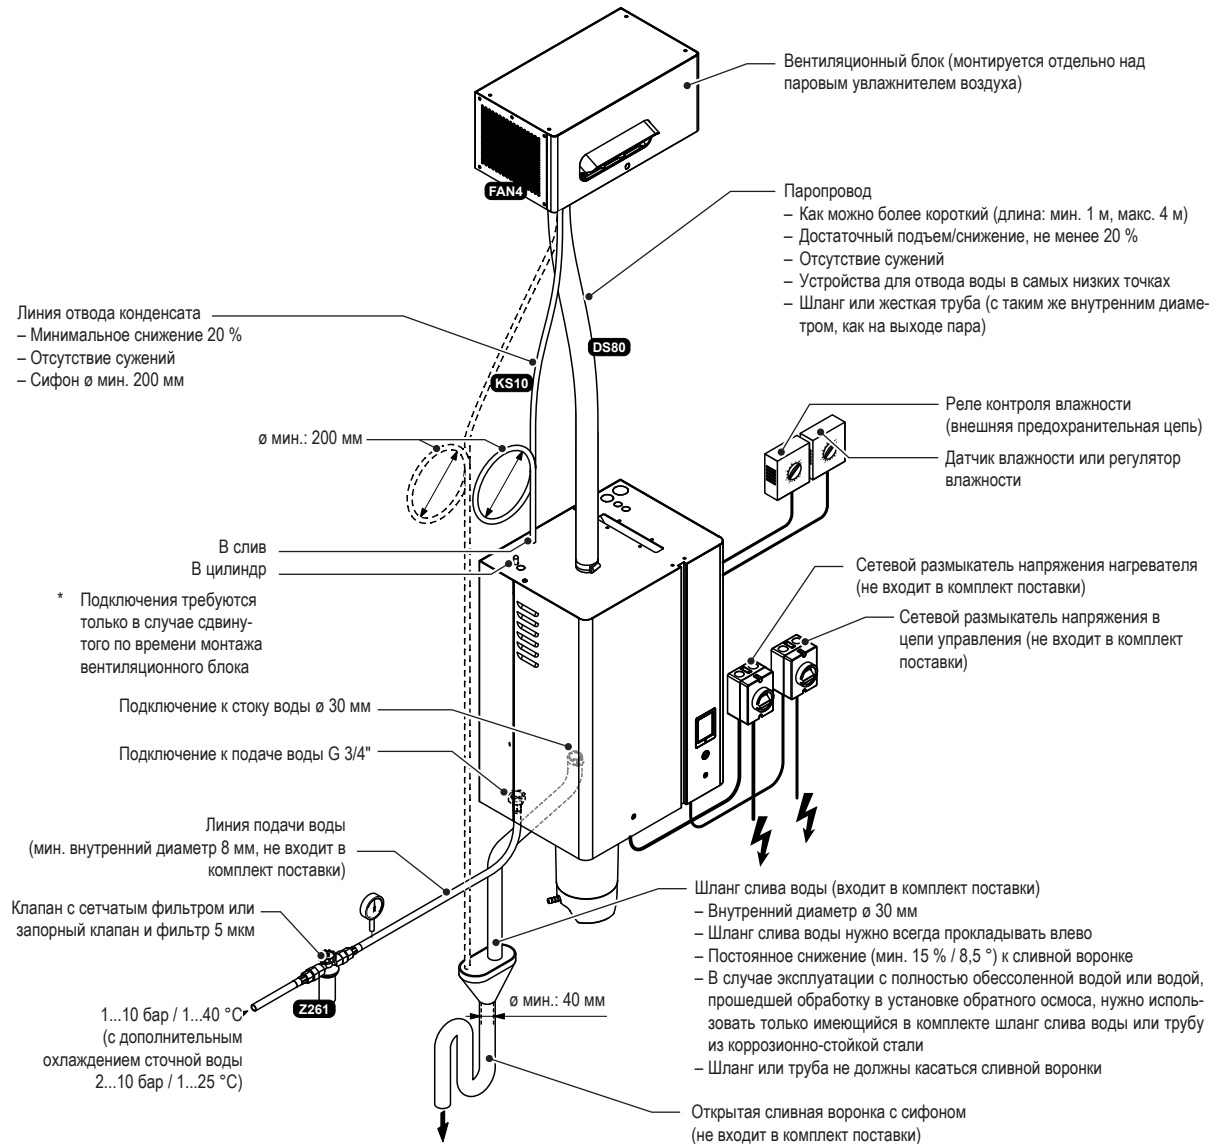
Типовая схема монтажа для системы прямого увлажнения воздуха в помещении
